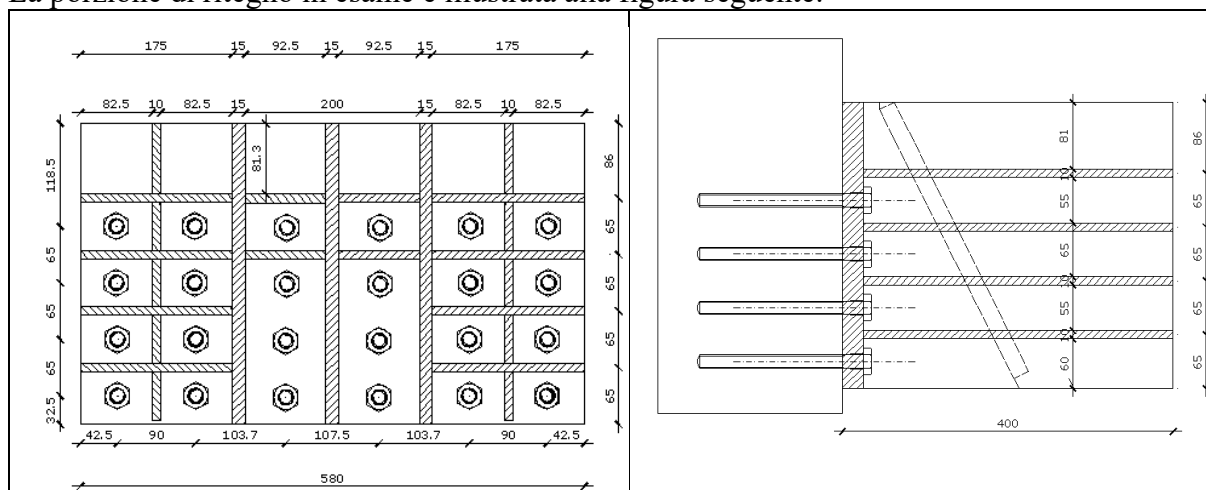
Geometria ritegno longitudinale su spalla
